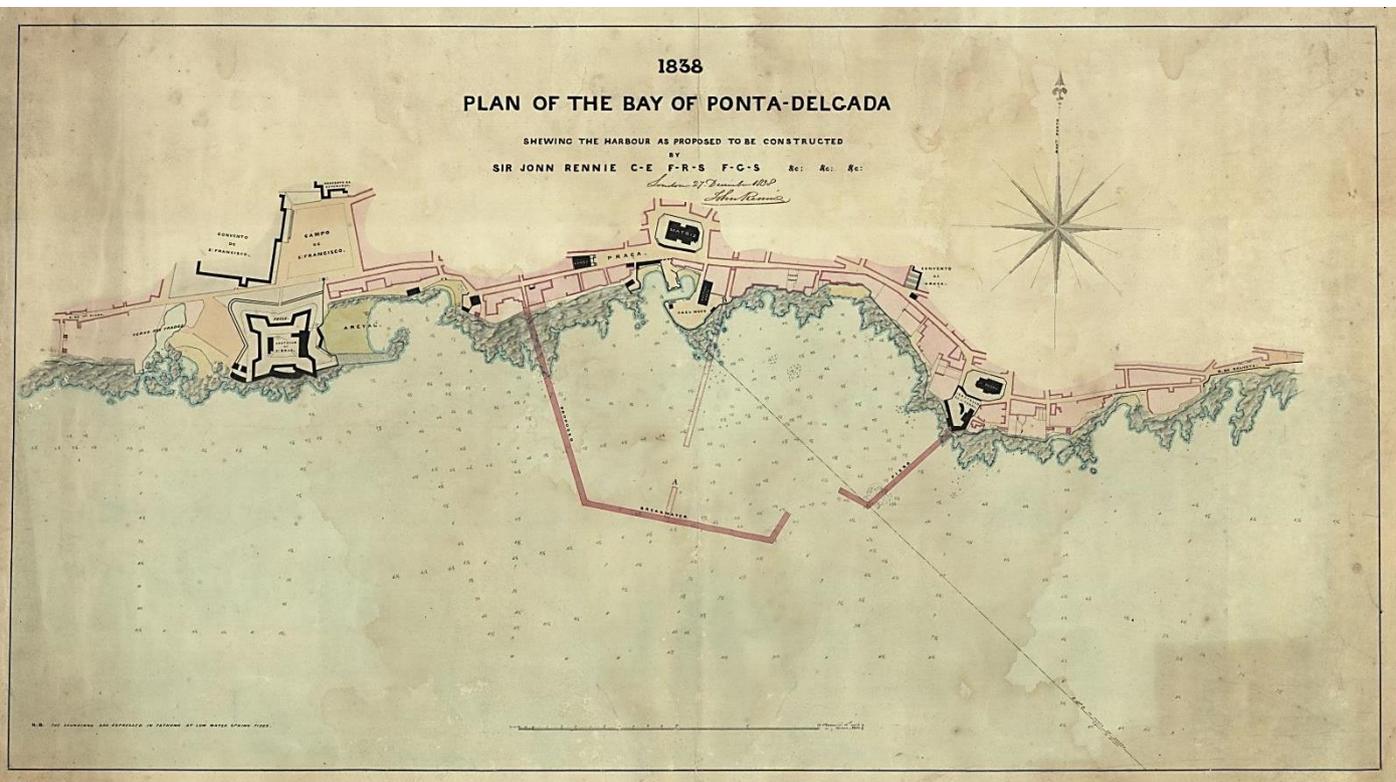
Planta da 1ª proposta de Sir John Rennie para o Porto de Ponta Delgada, 1838.
